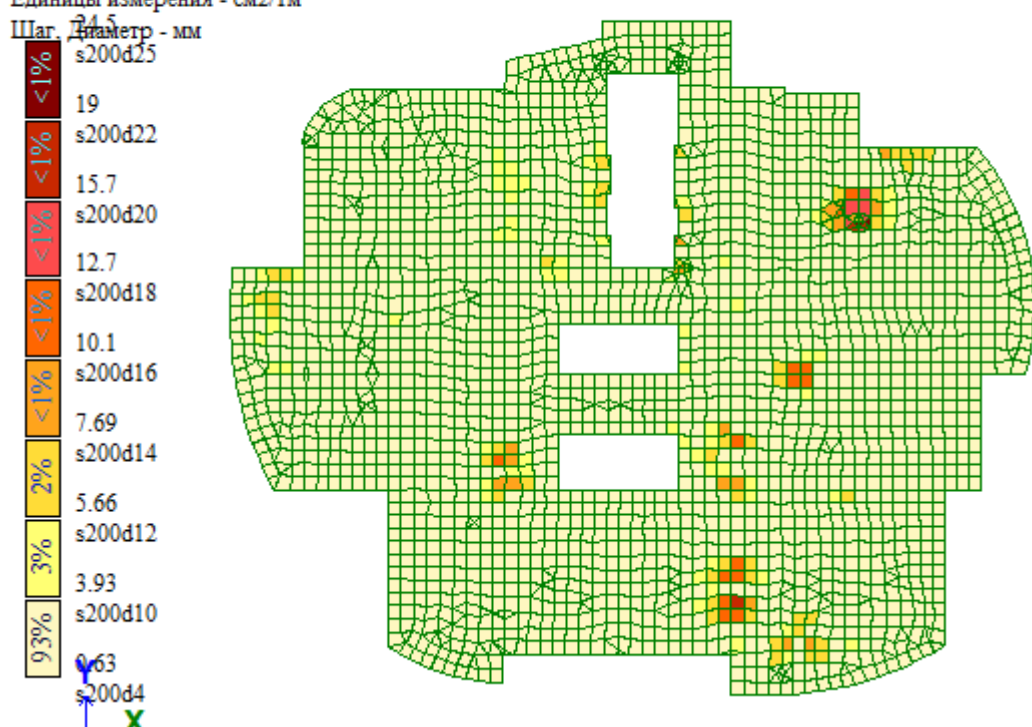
Схема армирования низа плит по оси ОУ
